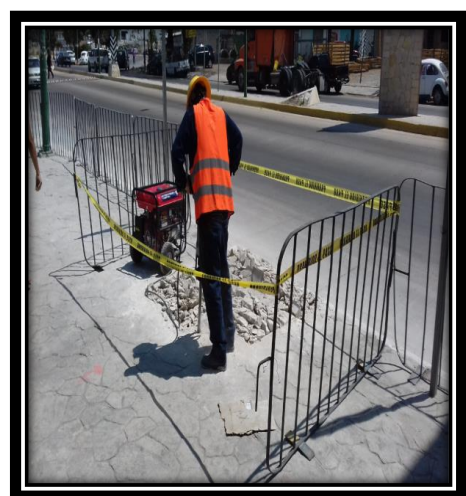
Zanja terminada en banqueta. Figura 3.15.-Demolición para zanja.
